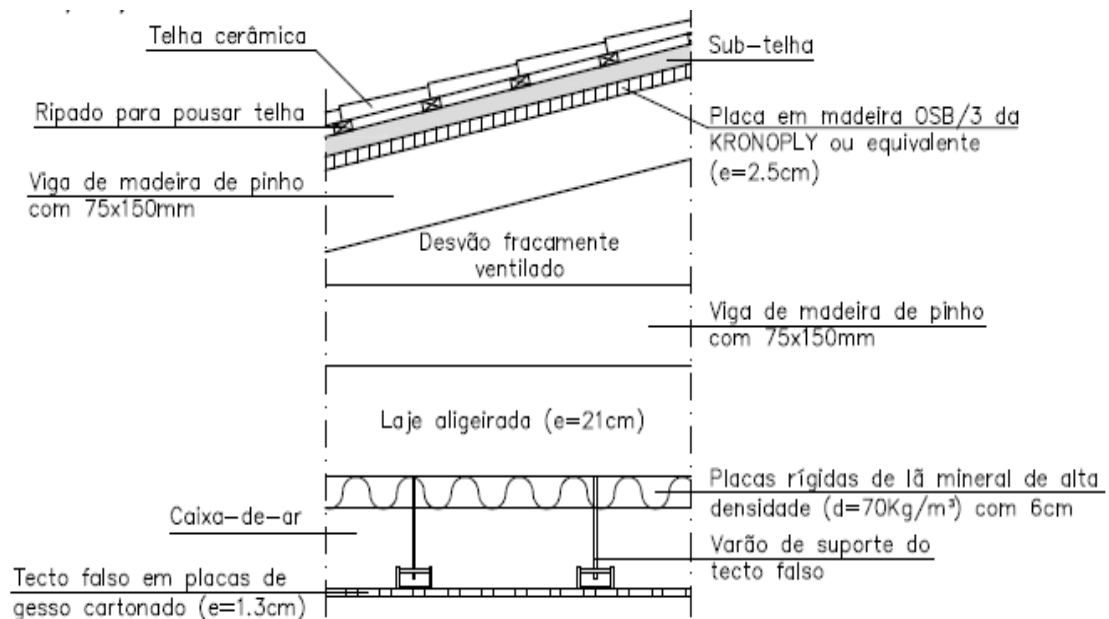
Pormenor da laje da cobertura com um espaço não aquecido
